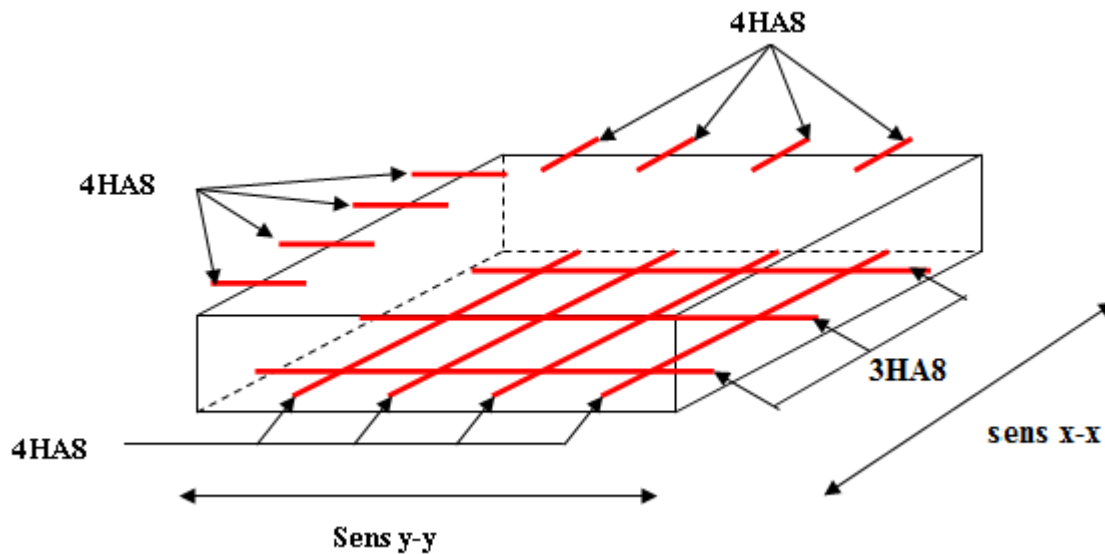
Schéma de ferrailage de la dalle pleine au-dessous de l'ascenseur.
